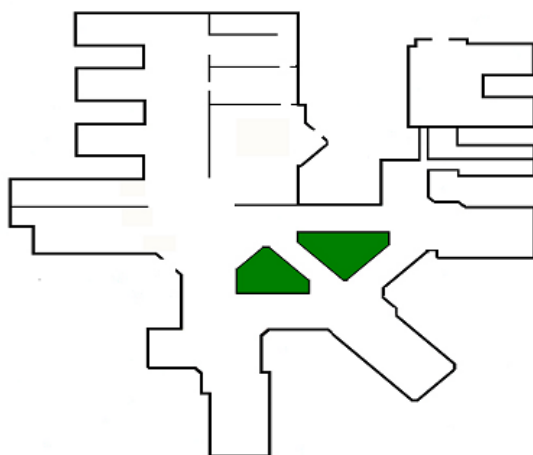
Grundriss Kreisklinik Altötting
